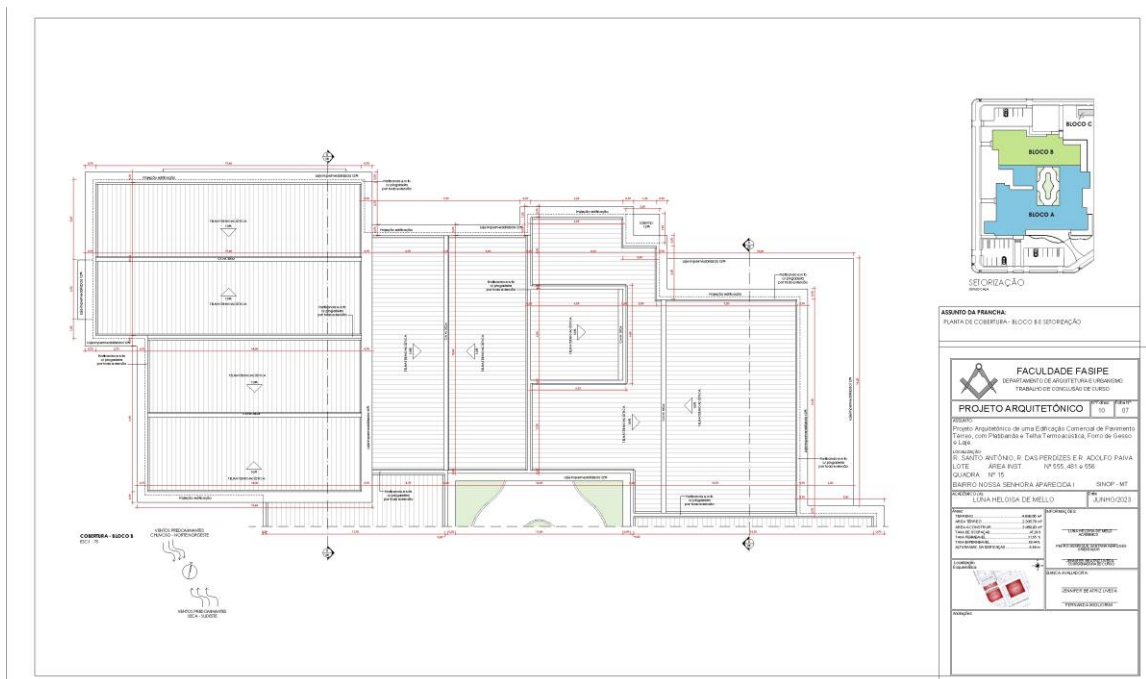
Projeto Arquitetônico – Layout Bloco B.
